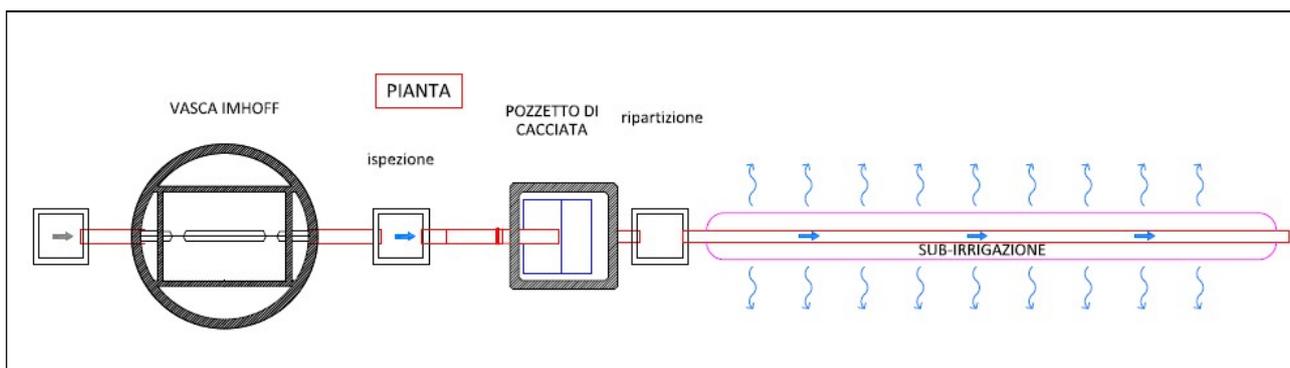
Pianta del sistema di trattamento appropriato Imhoff + Subirrigazione
